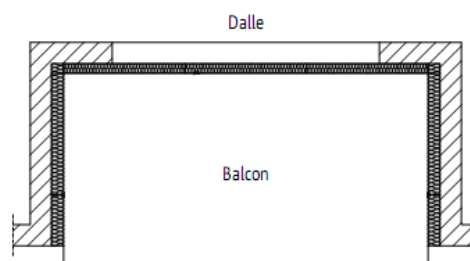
Balcon en béton armé appuyé sur trois côtés.
